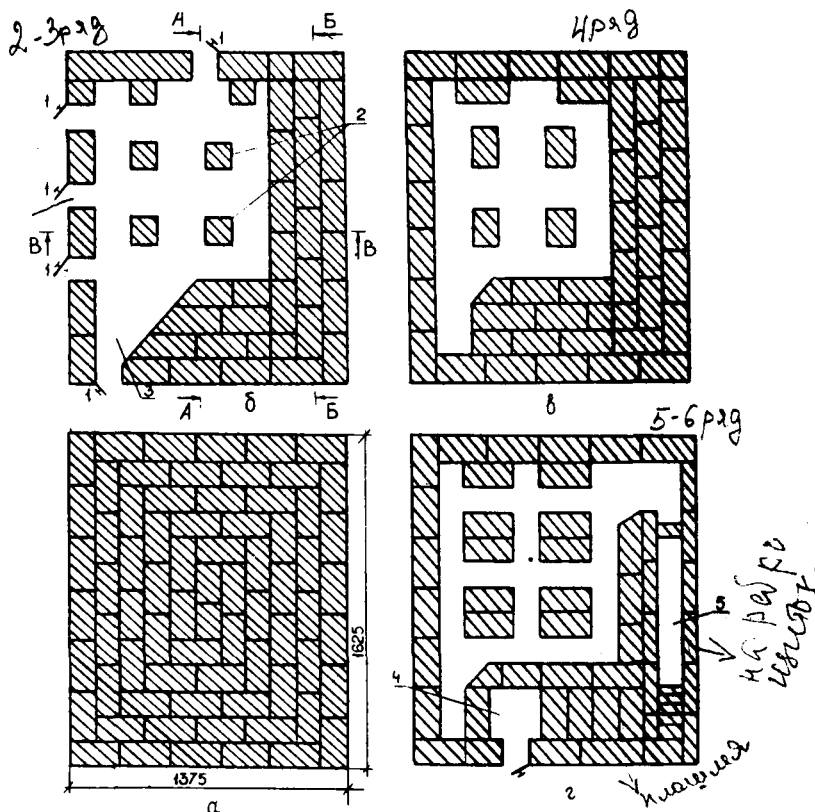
Кладка печи № 2 с 1-го по 6-й ряд: а — 1-й ряд; б — 2—3-й ряды; в — 4-й ряд; г — 5—6-й ряды; 1 — окна чистки; 2 — опоры пода; 3 — канал под зимнюю задвижку; 4 — зольник; 5 — канал обогревательного щитка
